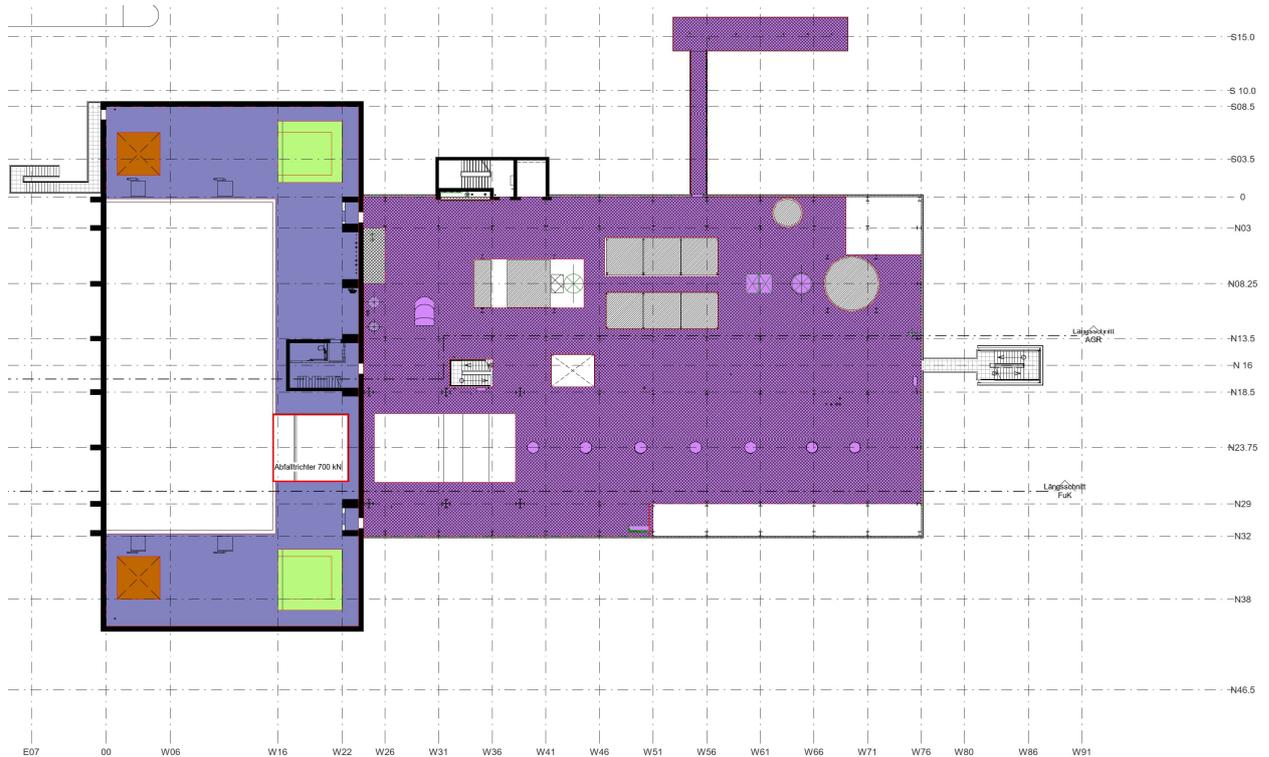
Nutzlasten Grundriss +21.60m
